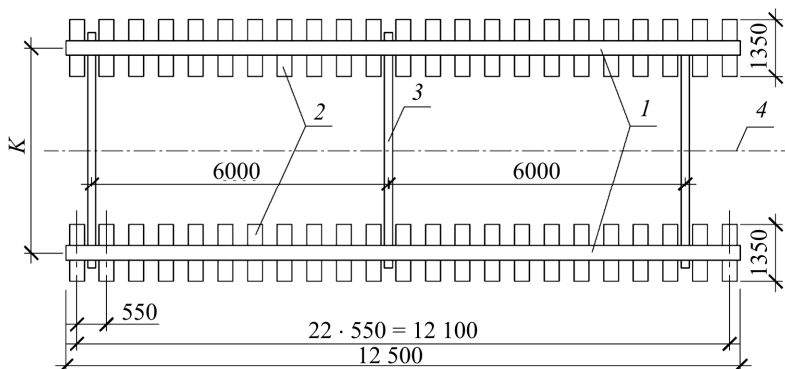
План подкранового пути на деревянных полушпалах с расположением металлических стяжек при равнодействующей давления на ходовое колесо от 22 до 28 тс: K – размер колеи; 1 – рельс; 2 – деревянные полушпалы; 3 – металлическая стяжка; 4 – ось подкрановых путей
